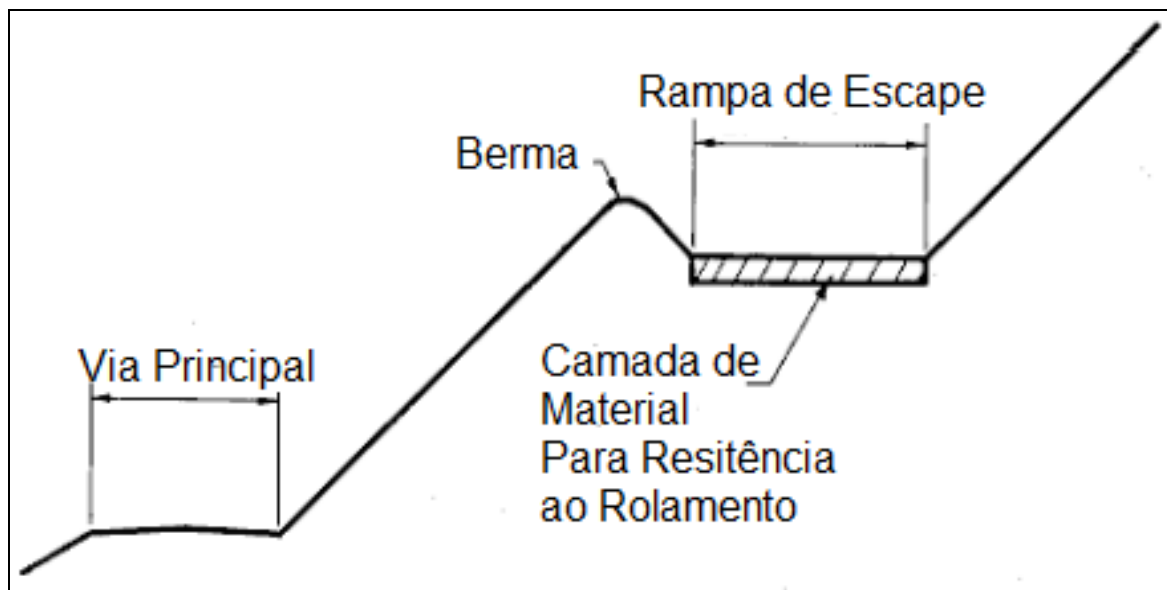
Estrada de Mina - Seção Tipo - Rampa de Escape Áreas: Entrada, Desaceleração e Parada.
